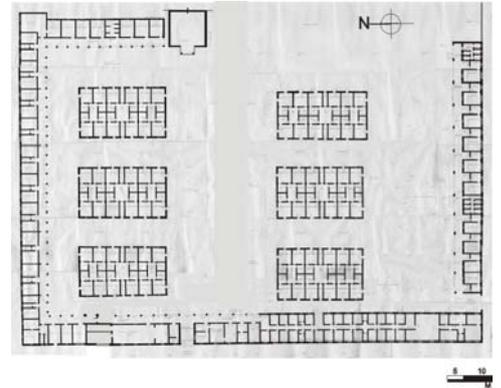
“Vila Vicentina”. Planta baixa com acréscimos posteriores.
